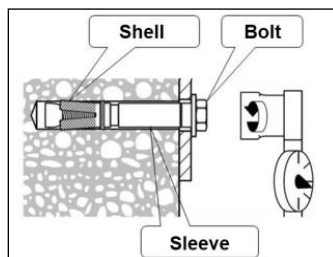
Ancrage HSLG utilisé pour la poutre BC4
